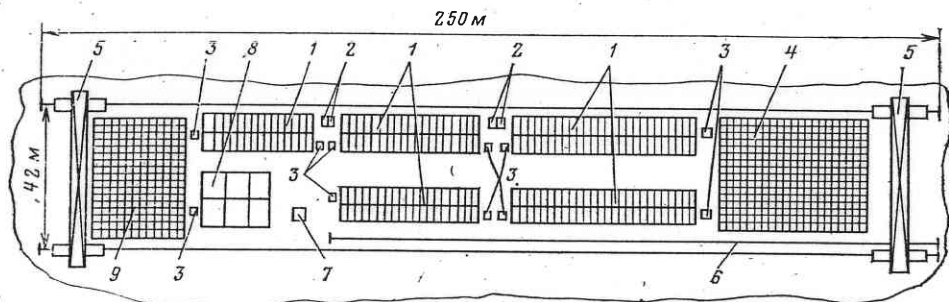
Площадка для укрупнительной сборки и ревизии механического оборудования:
